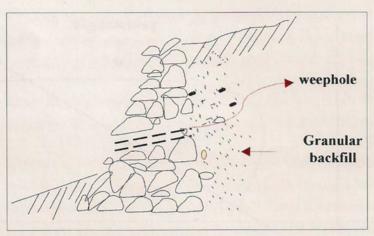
POTONGAN CERUN BAGI KESTABILAN
